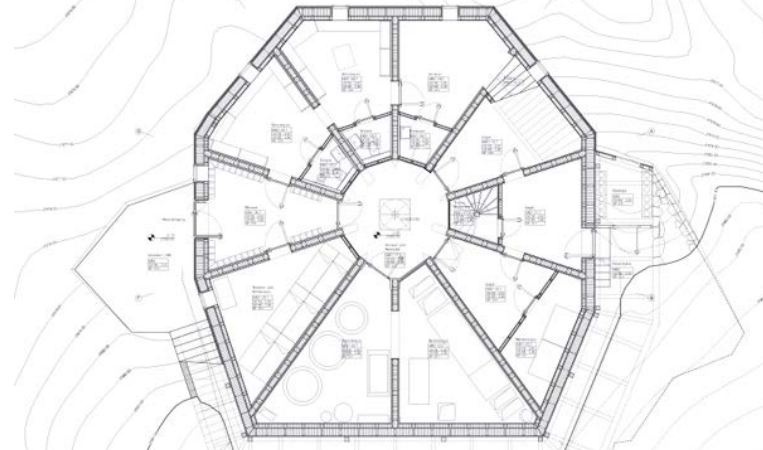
Pianta piano seminterrato del Monte Rosa Hütte
